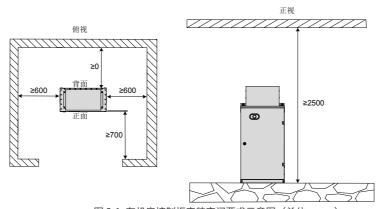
有机房控制柜安装空间要求示意图(单位: mm)
